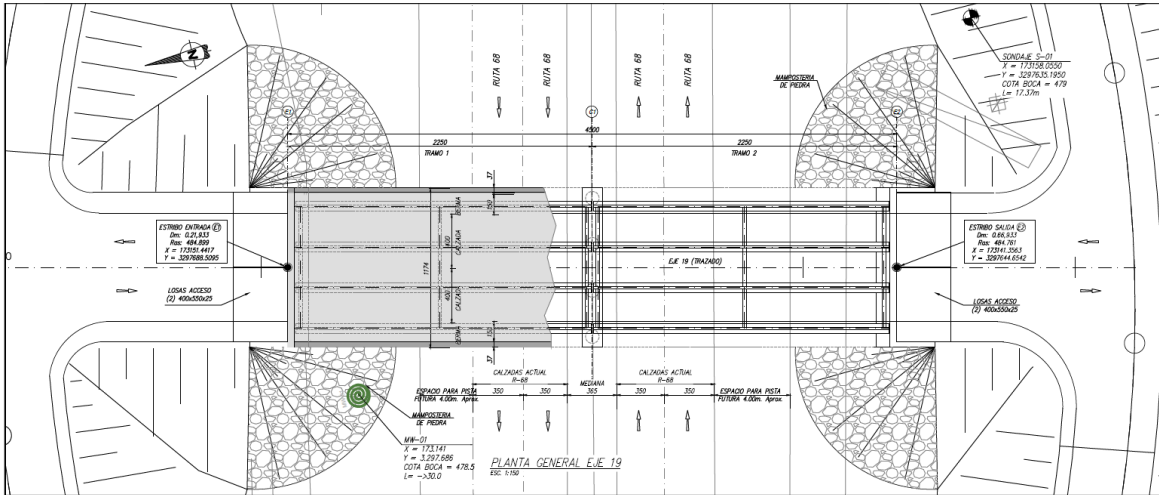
Vista en planta del Puente San Pablo Antigua. Fuente: Planos de Proyecto.
